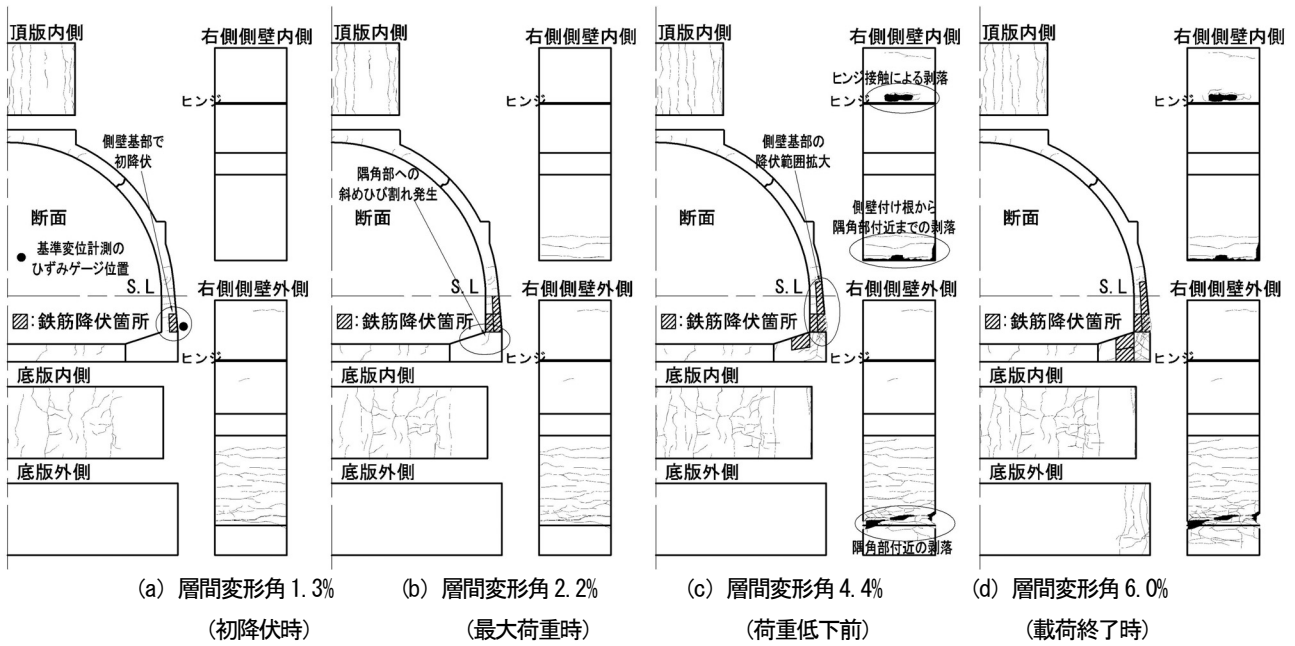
ひび割れ損傷図 (2 ヒンジ)
